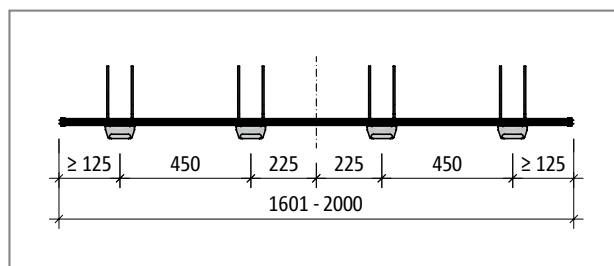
Schöck Tronsole® tipo T-V4-H...-L1601 - L2000, pianta del prodotto
